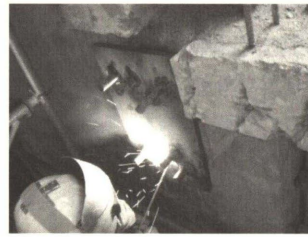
梁筋プレート定着梁筋定着プレート溶接状況
